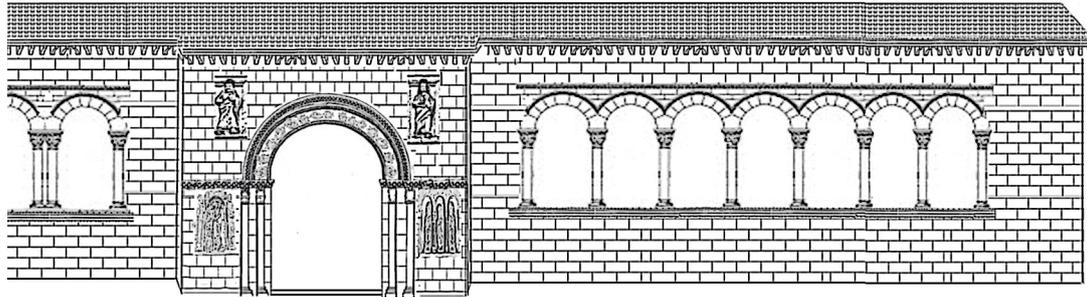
Propuesta de reconstrucción de la galería porticada (Dibujo del autor)
